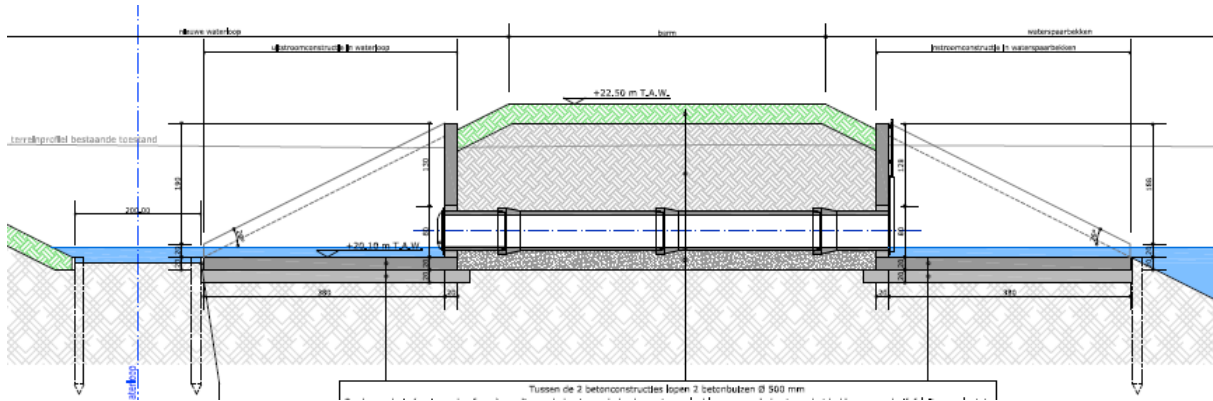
Detailplan van de voorziene stuwconstructie in de Ringbeek¹²
